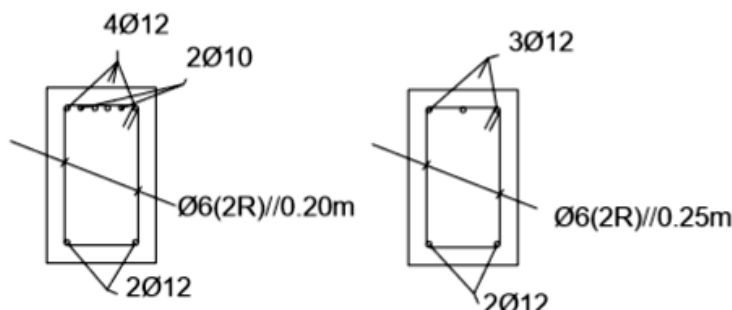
Secções transversais das vigas do Edifício 2. Da esquerda para a direita: Viga 2 e Viga 1.
